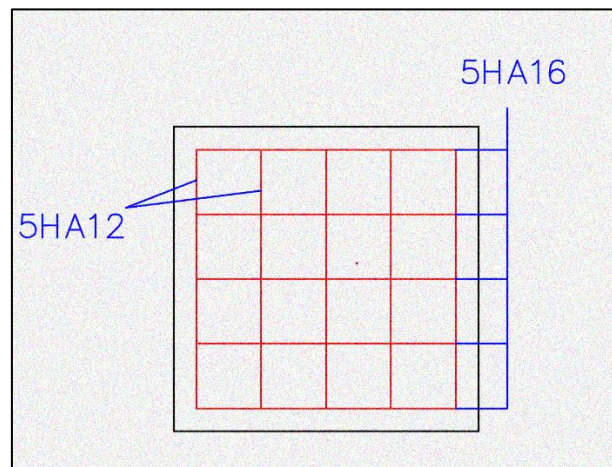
Le vue en plan de ferrailage du dé d'appui.
